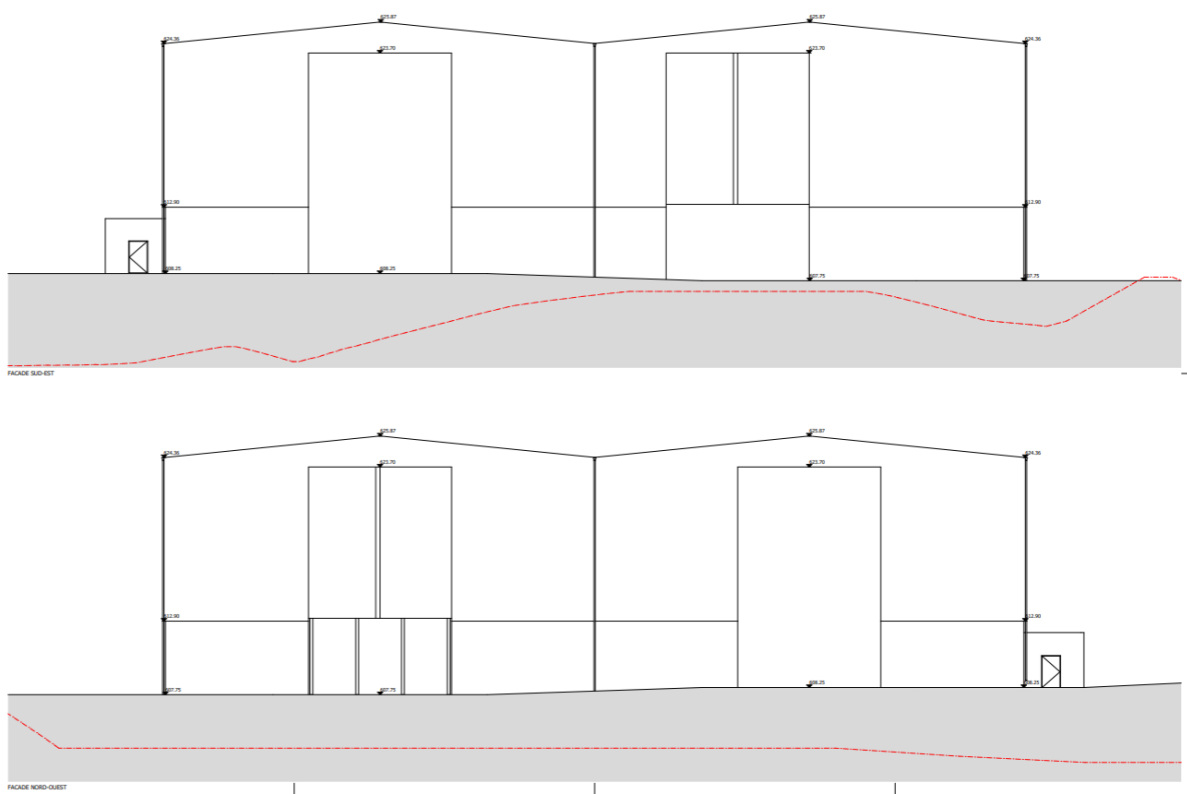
(Haut) Façade sud-est du hangar 6. (Bas) Façade nord-ouest du hangar 6. Extrait de [1].
